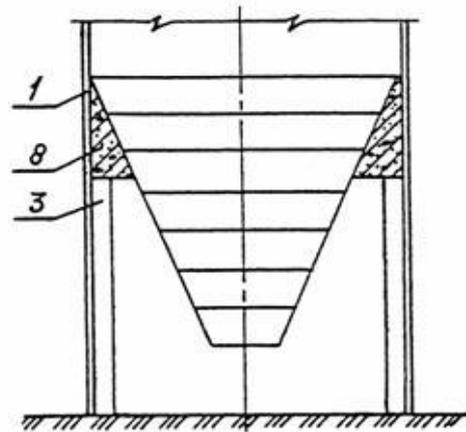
Усиление узлов крепления и сопряжения стальной воронки с железобетонной стеной силоса:
